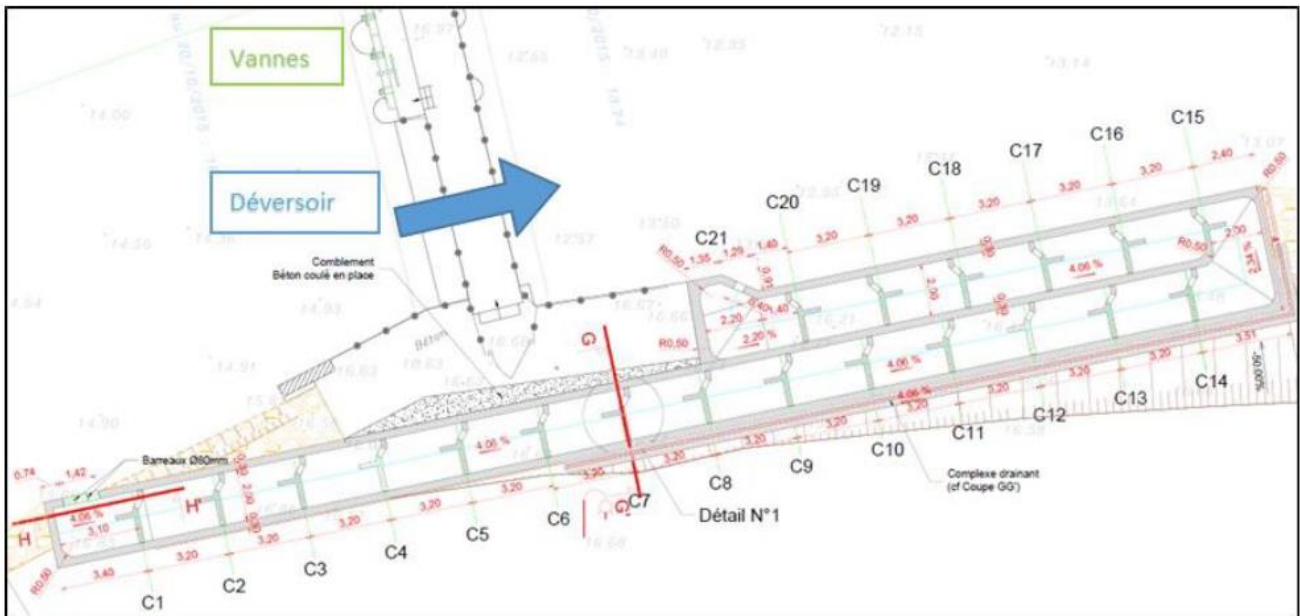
Vue en plan du scénario 2 – OH V (source : SUEZ CONSULTING pour ARIANEGROUP)
